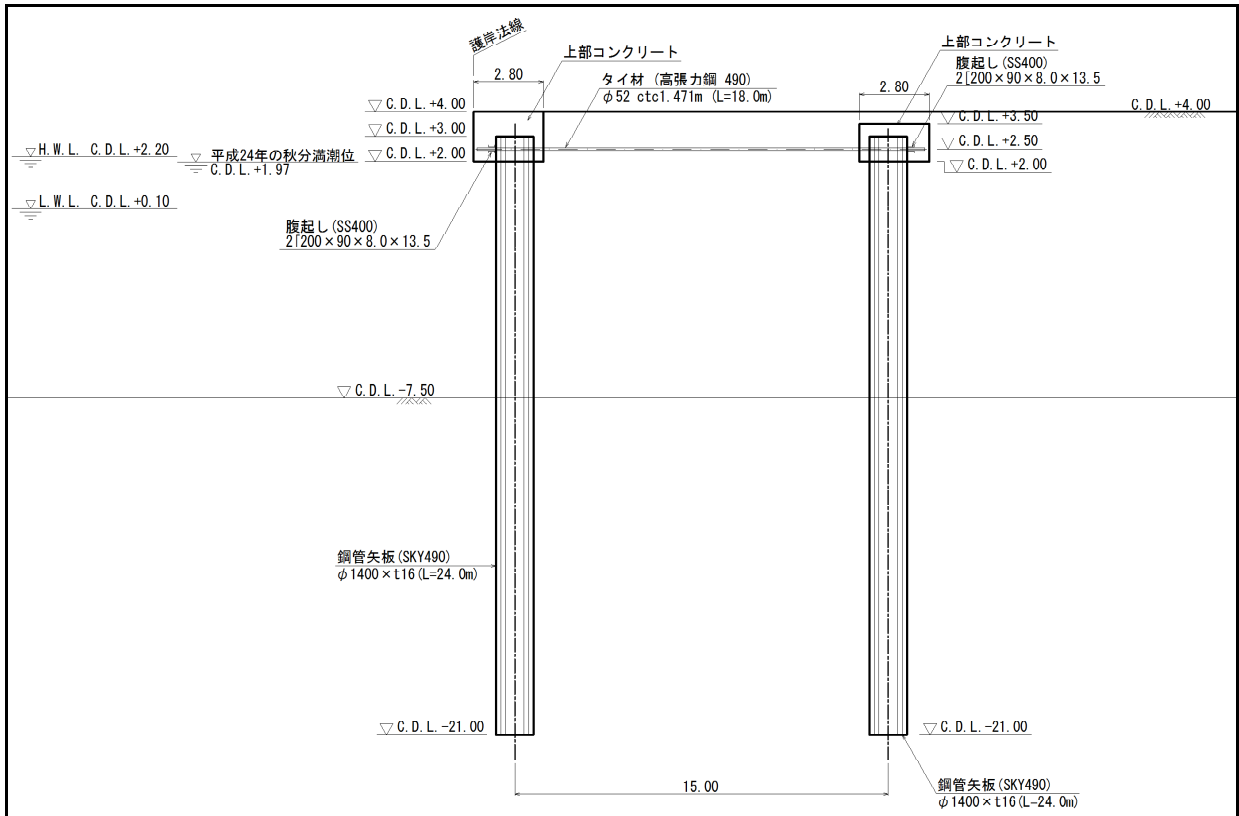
中仕切岸壁 A (-7.5m) 標準断面図
